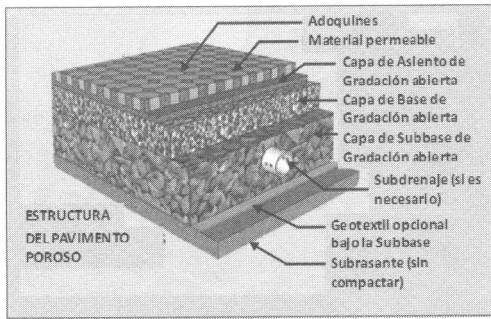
Estructura típica de un pavimento poroso del tipo PICP (7).
